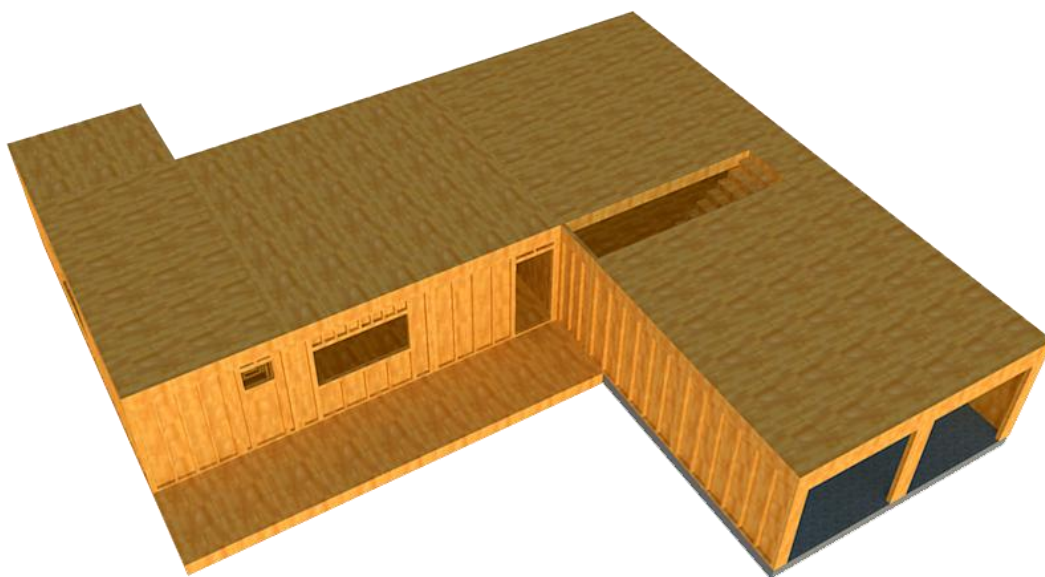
Etapa 3: Piso superior do pavimento térreo e pisos do 1º pavimento
